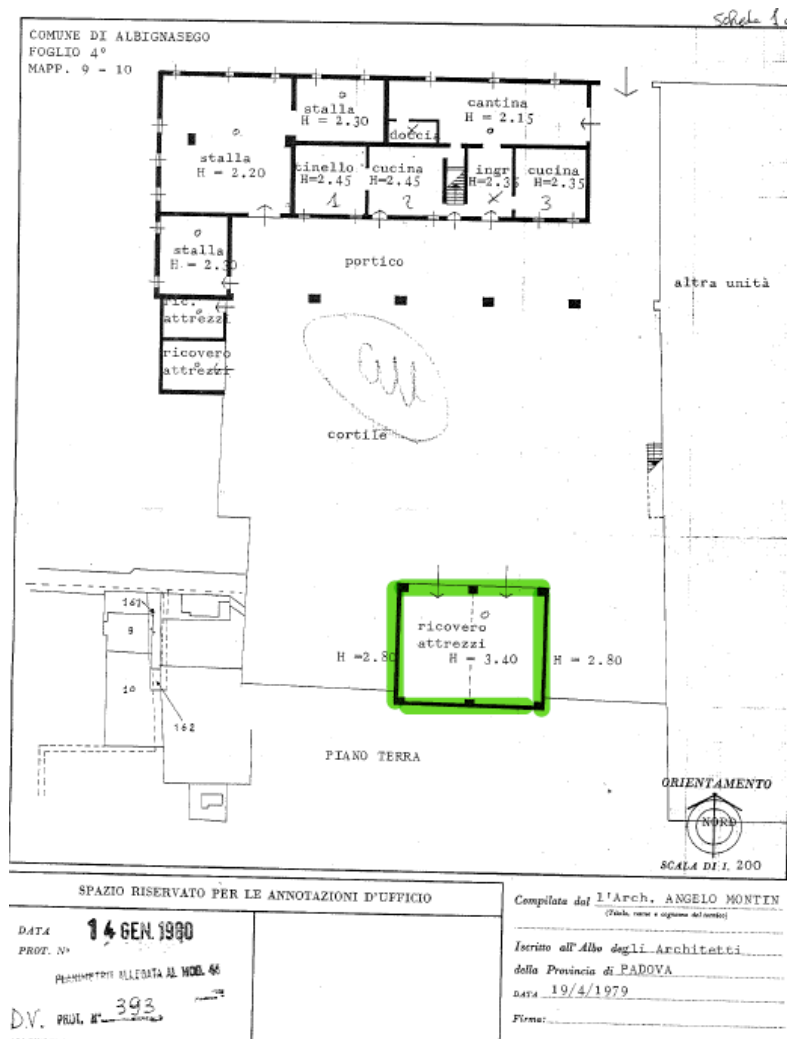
Planimetria catastale – SDF – Edificio oggetto di richiesta evidenziato in verde.
